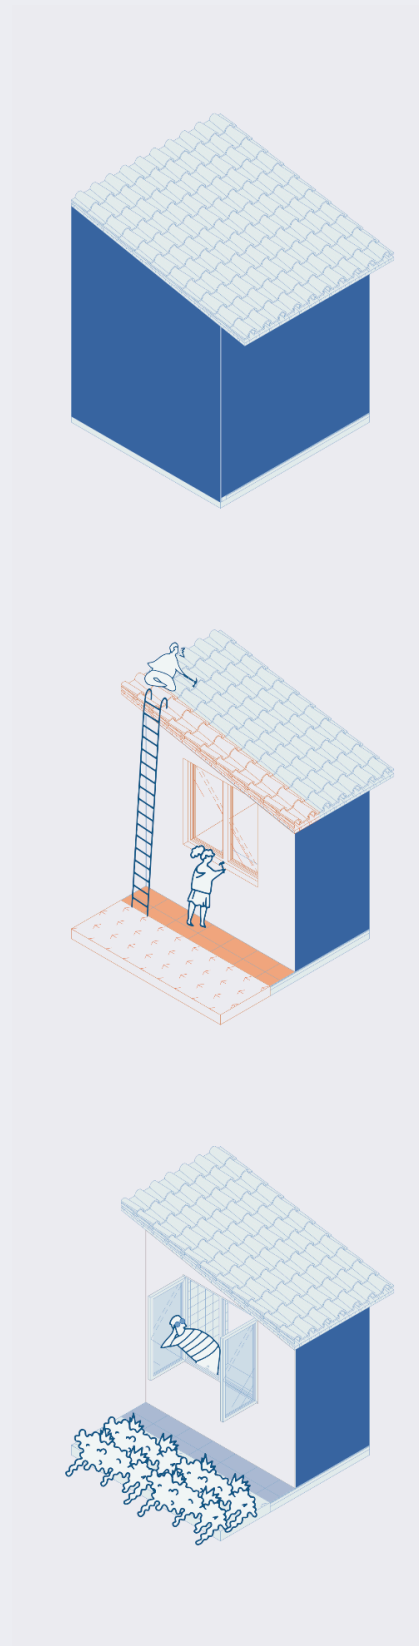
Estratégia de Aberturas de Janelas e Protegê-las; Demolição de Paredes Internas
